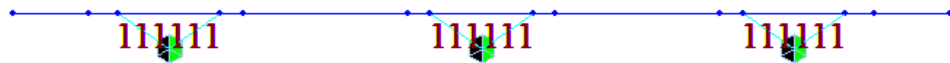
Modello FE sezione trasversale - Vista trasversale
